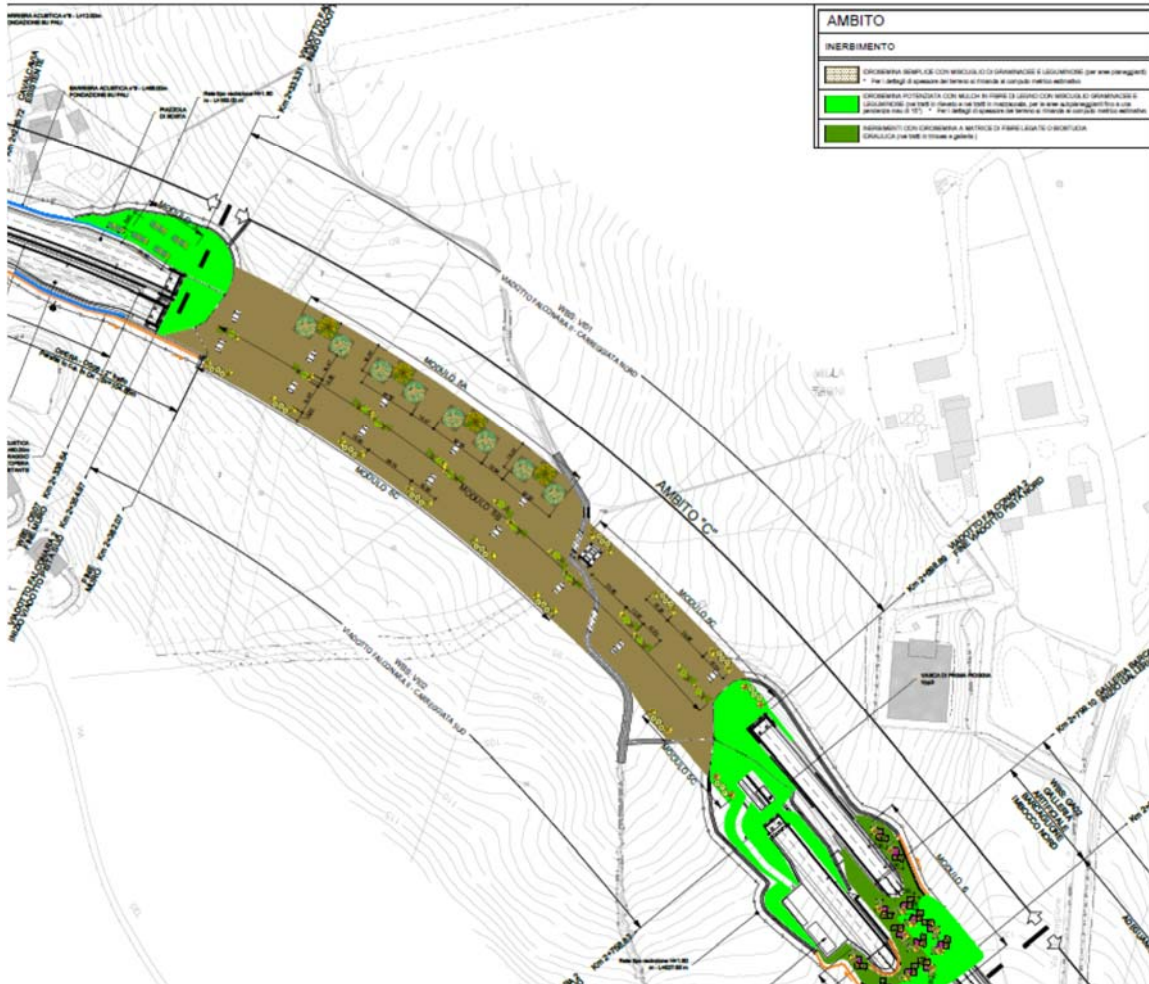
Estratto della planimetria delle opere a verde – Intervento 1
